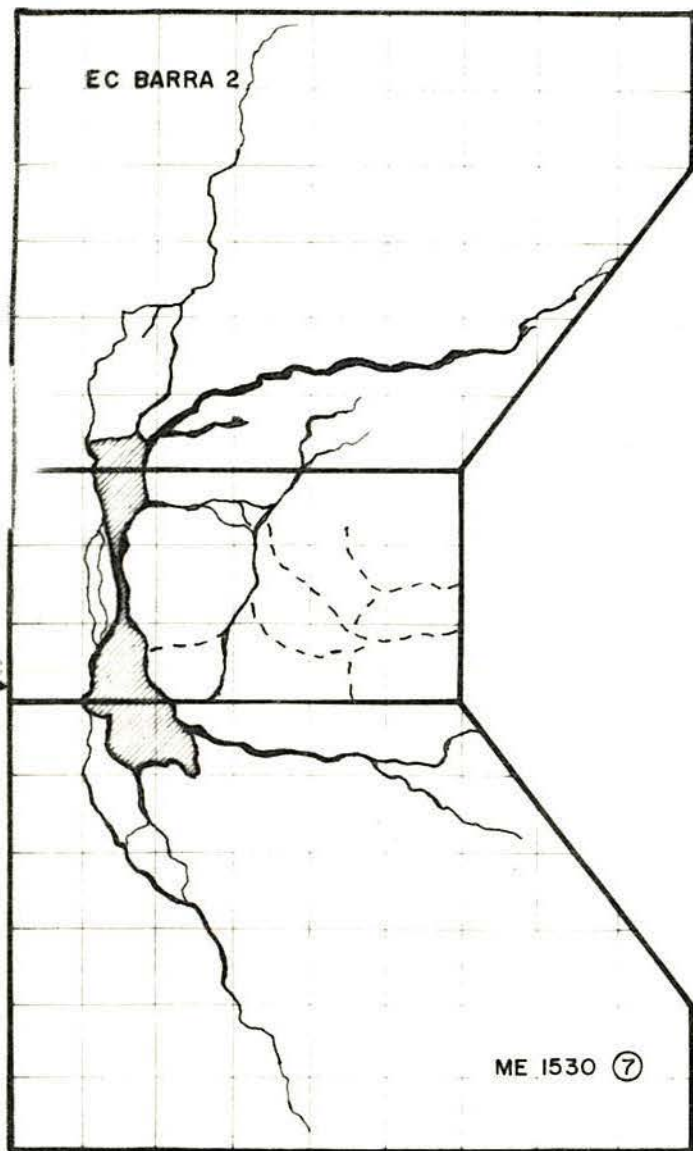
Fissuração dos CP ME1530
